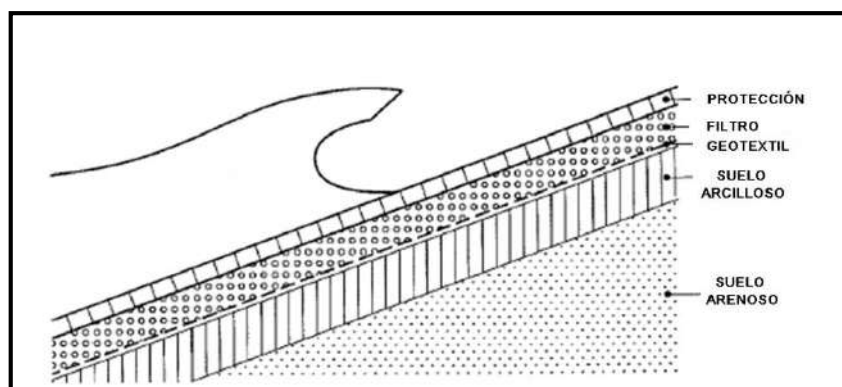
Perfil tipo con los elementos de protección y filtros del talud
